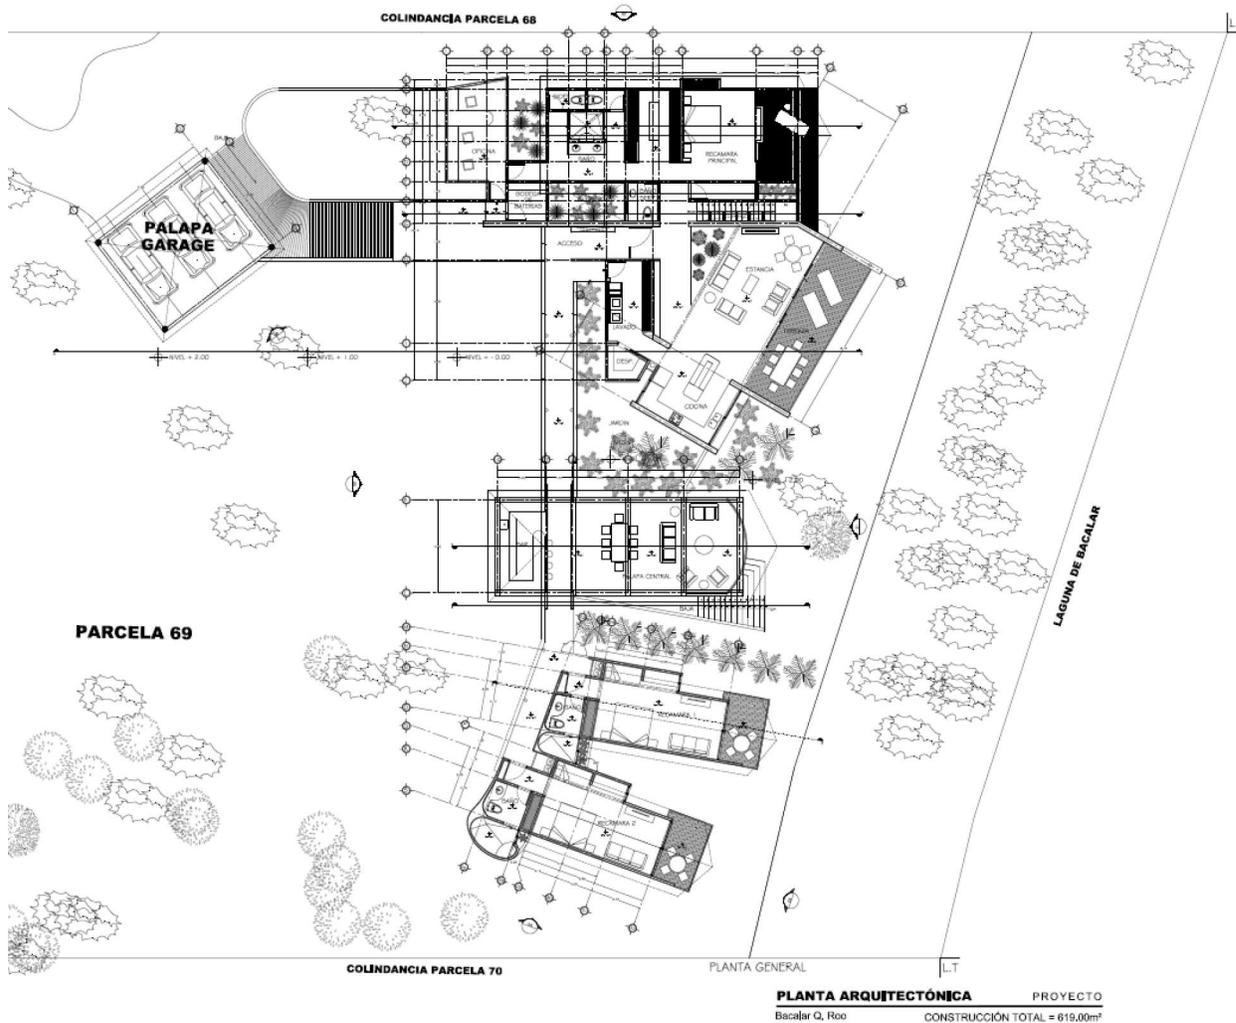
Plano arquitectónico del proyecto CASA CAMINO AL VIENTO.
